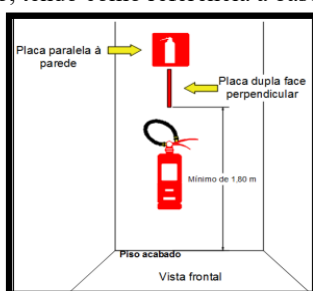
Placa com indicação extintor deve ser colocada a 1,80 do piso do chão.
